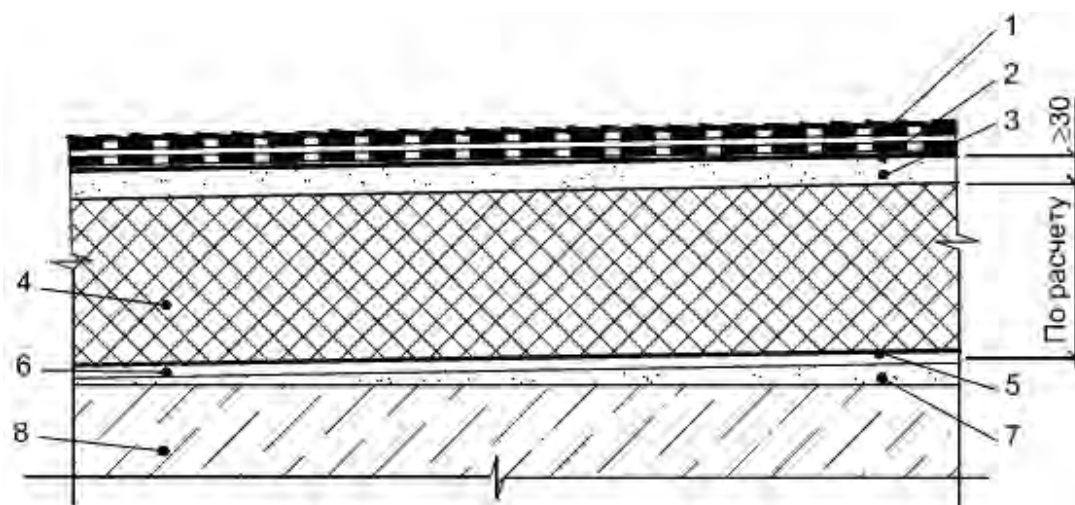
Неэксплуатируемая кровля с утеплителем и сплошной наклейкой (наплавкой) водоизоляционного ковра: 1 – водоизоляционный ковер; 2 – грунтовка; 3 – стяжка; 4 – теплоизоляция; 5 – пароизоляция; 6 – выравнивающая стяжка (затирка); 7 – разуклонка из легкого бетона; 8 – несущая конструкция покрытия
